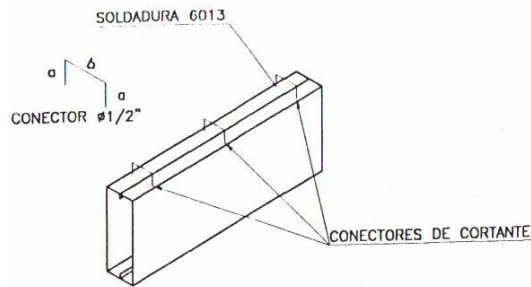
Detalle Testero (Soldadura E-6013).
